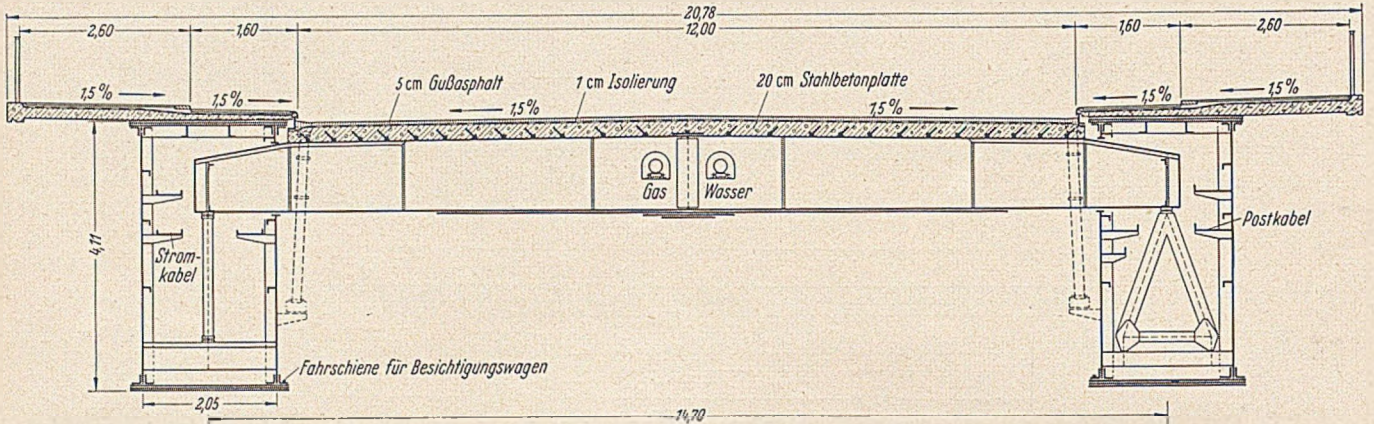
a) Querschnitt durch die Konstruktion der Rheinbrücke Koblenz—Pffaffendorf. b) Stahlkastenträger im Achsabstand von 14,70 m. Stahlquerträger auf Pendelstützen und -böcken gelagert. Stahlbetonfahrbahn in Verbund mit den Querträgern. Fahrbahnbreite 12,00 m, beiderseitige Radwege von 1,60 m und Gehwege von 2,60 m auf ausgekragten Stahlbetonplatten. Gesamtbrückenbreite einschl. Gesims für Geländer 20,78 m. Die Versorgungsleitungen für Gas und Wasser sind auf Rollen gelagert durch die Querträger hindurchgeführt.
